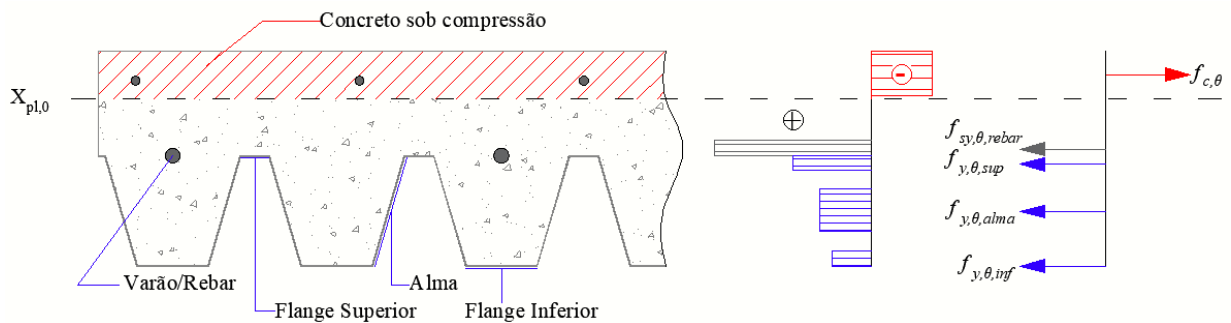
Distribuição de tensões na seção da laje para situação de ELU para instante t_0
